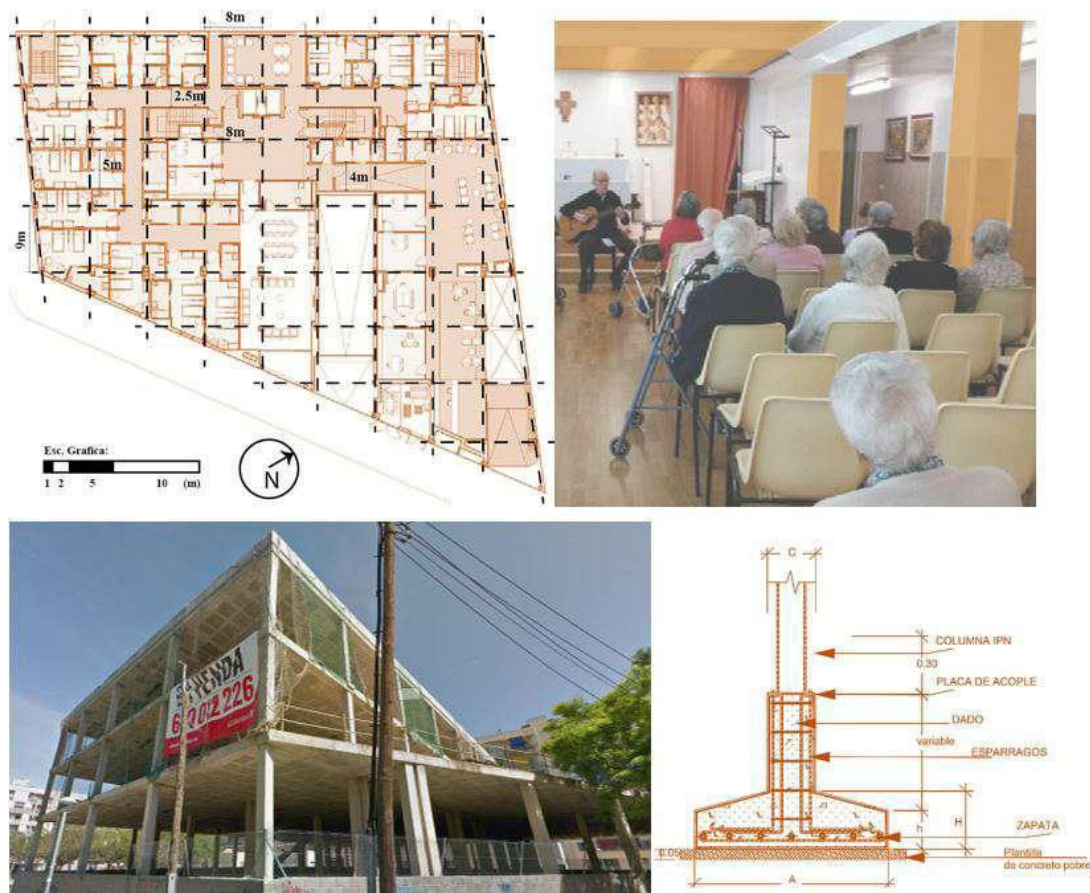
Cimentación. Fuente: [Trepas \(2022\)](#)
